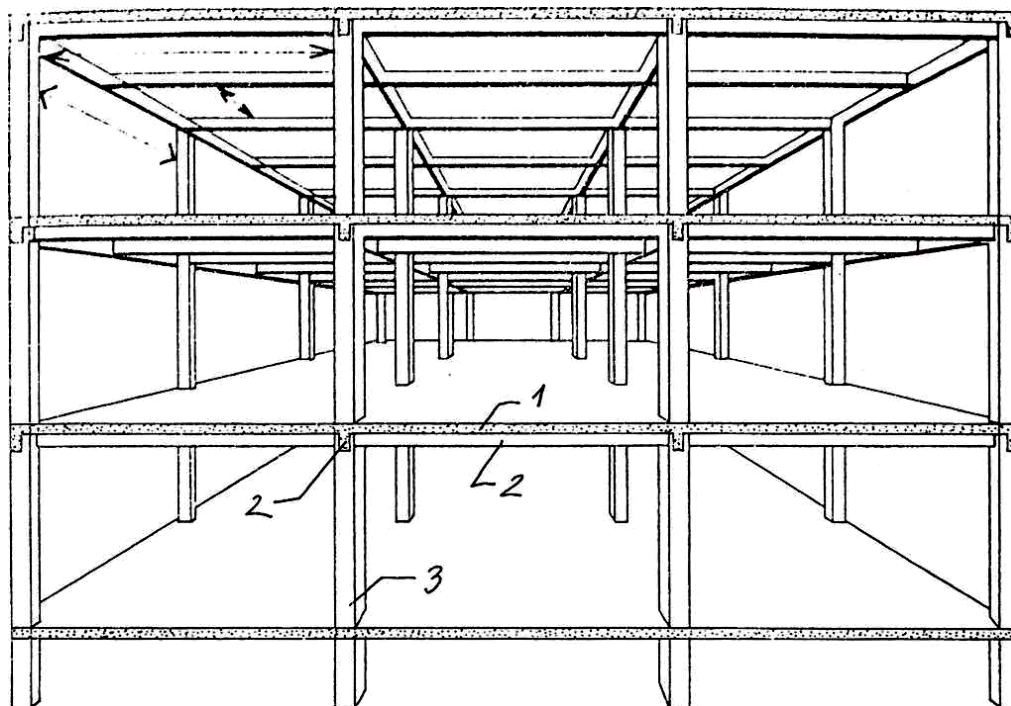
Монолитна стоманобетонна конструкция; 1 - плоча (slab); 2 - греди (beam); 3 - колона (column); 4 - стена (wall); 5 - фундамент (foundation)
